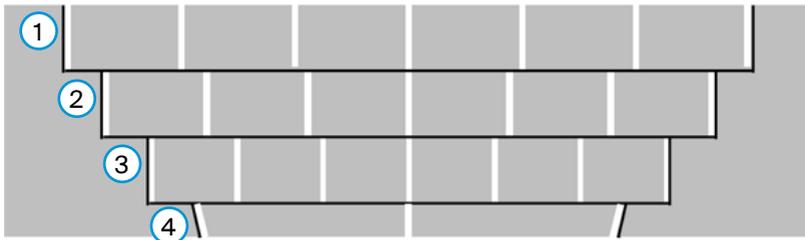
Deckendurchbruch mit Diamantwerkzeugen
